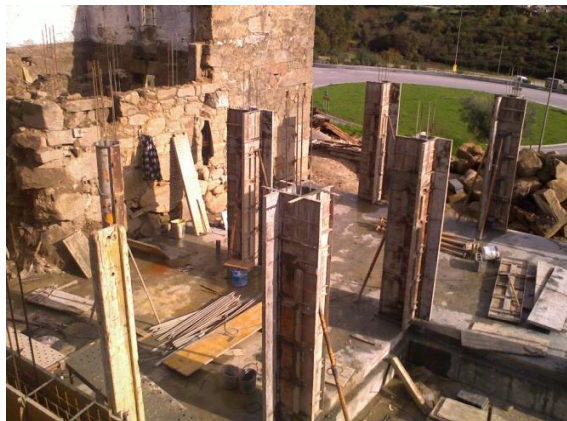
Cofragem dos pilares e sua betonagem.
